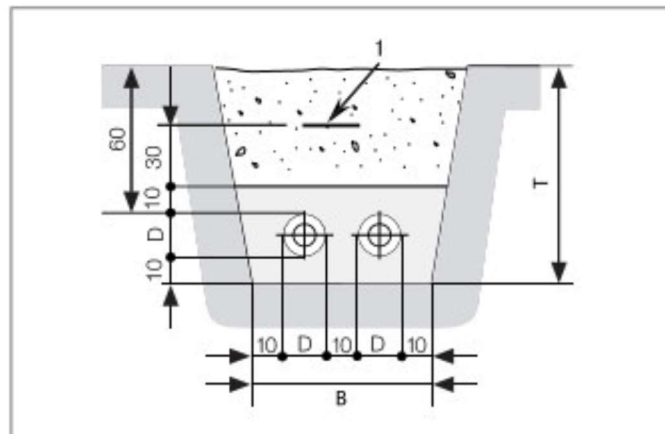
Sección de la zanja 2 tubos (UNO o DUO)
